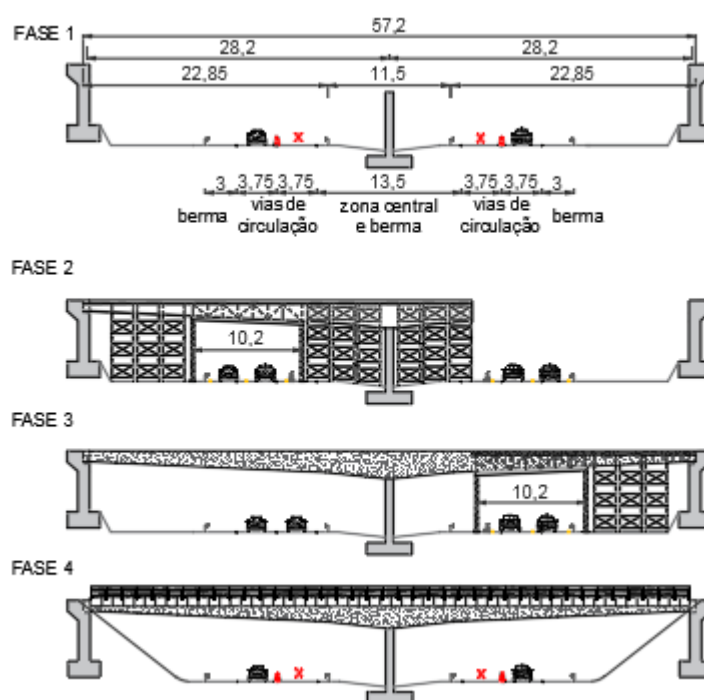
Faseamento construtivo da solução em betão armado pré-esforçado
